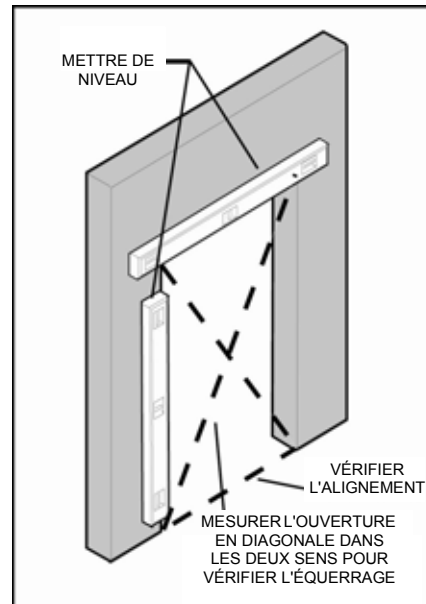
INSTALLATION DE PAROIS (EXEMPLE)
